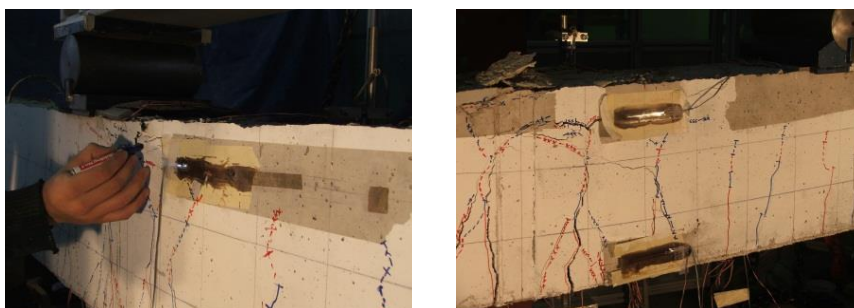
Marcado de fisuras durante el ensayo bajo cargas incrementales
